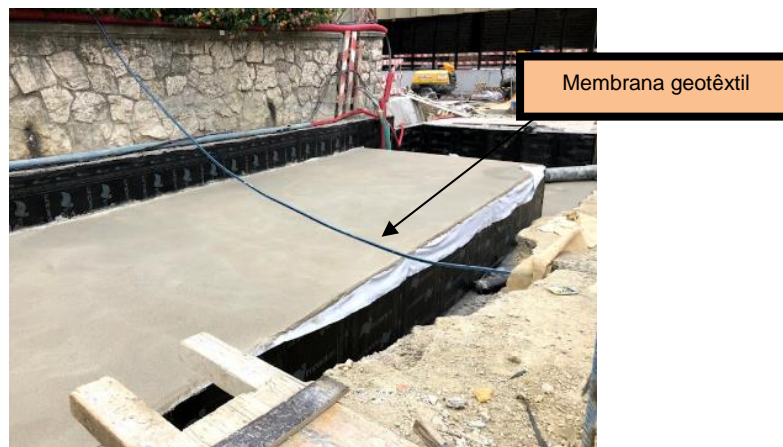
(obtida no local da obra a 12 de julho de 2018): Colocação da última camada constituinte do sistema de impermeabilização da laje de cobertura: manta geotêxtil
